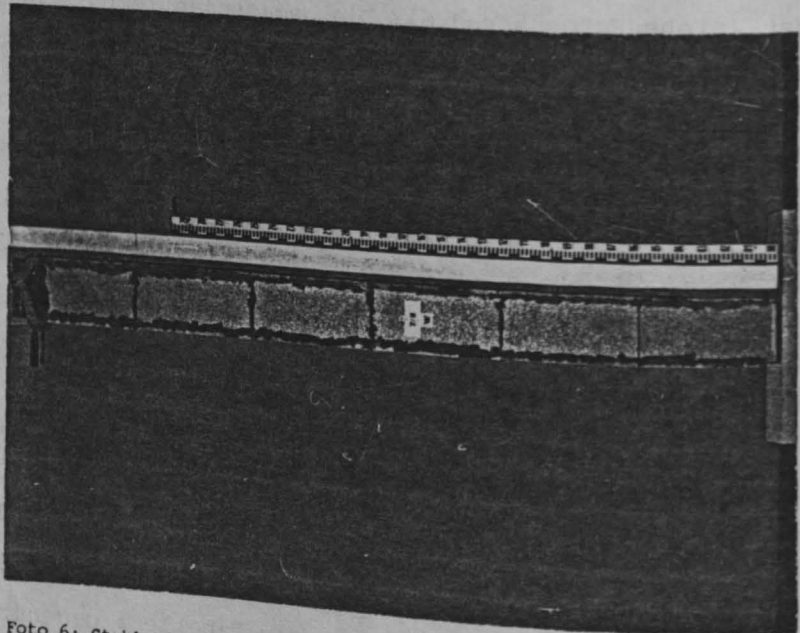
Stahlstütze mit teilweiser Bekleidung nach dem Brandversuch
